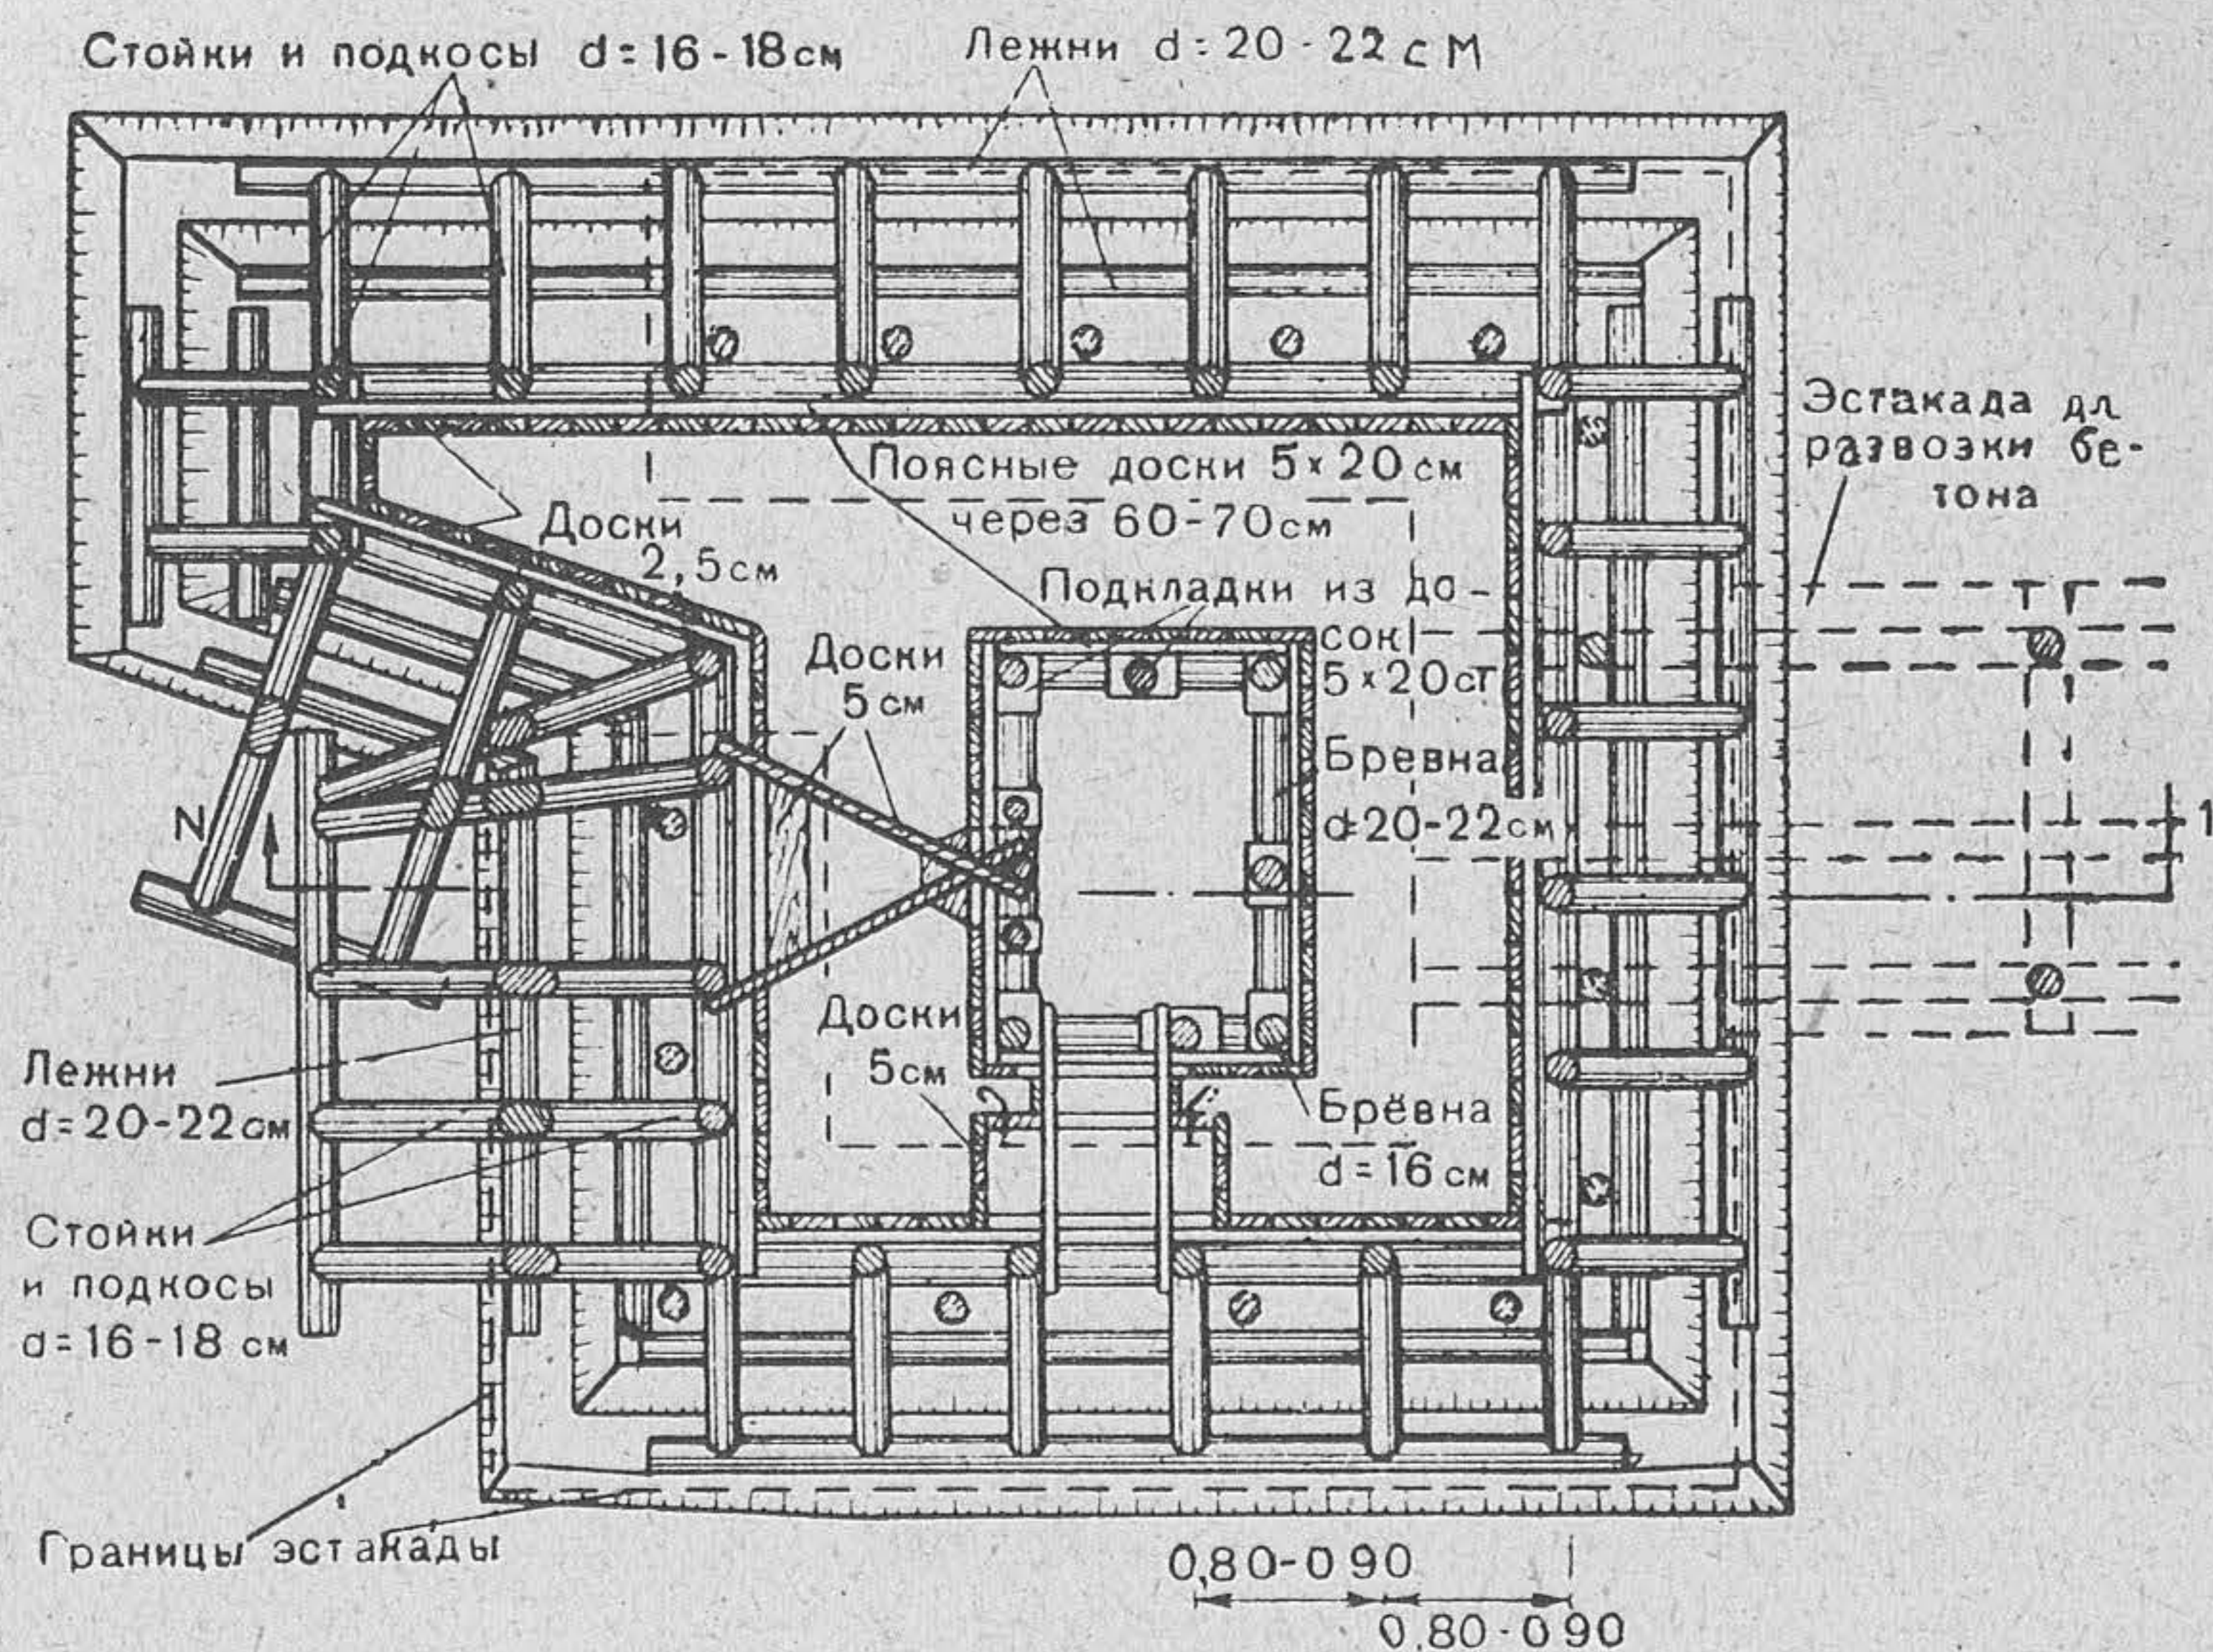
Эстакада и опалубка железобетонного фортификационного сооружения
